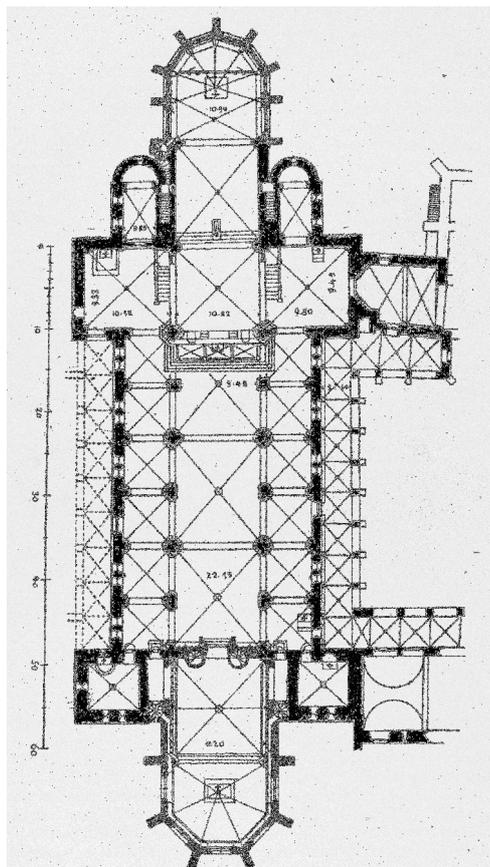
Grundriss des Naumburger Doms (nach BERGNER 1903, S. 32, Fig. 16), mit (unten) Westchor und flankierenden Unterbauten der Westtürme, welche den Zugang zum Laufgang des Westchors vermittelten. (Einen vergleichbaren Grundriss des Naumburger Doms und seines Westchors - den Hauptgegenständen des Naumburger Welterbeantrags - sucht man in ‚Macht. Glanz. Glaube‘ vergeblich.
